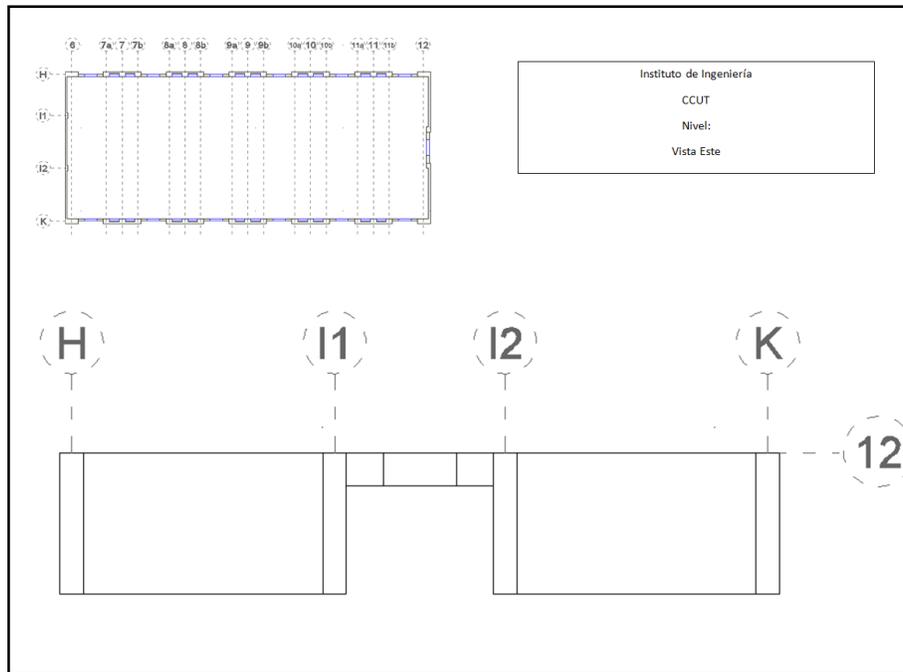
Elevación de columnas, muros y trabes, sobre eje 12 entre eje H y K
